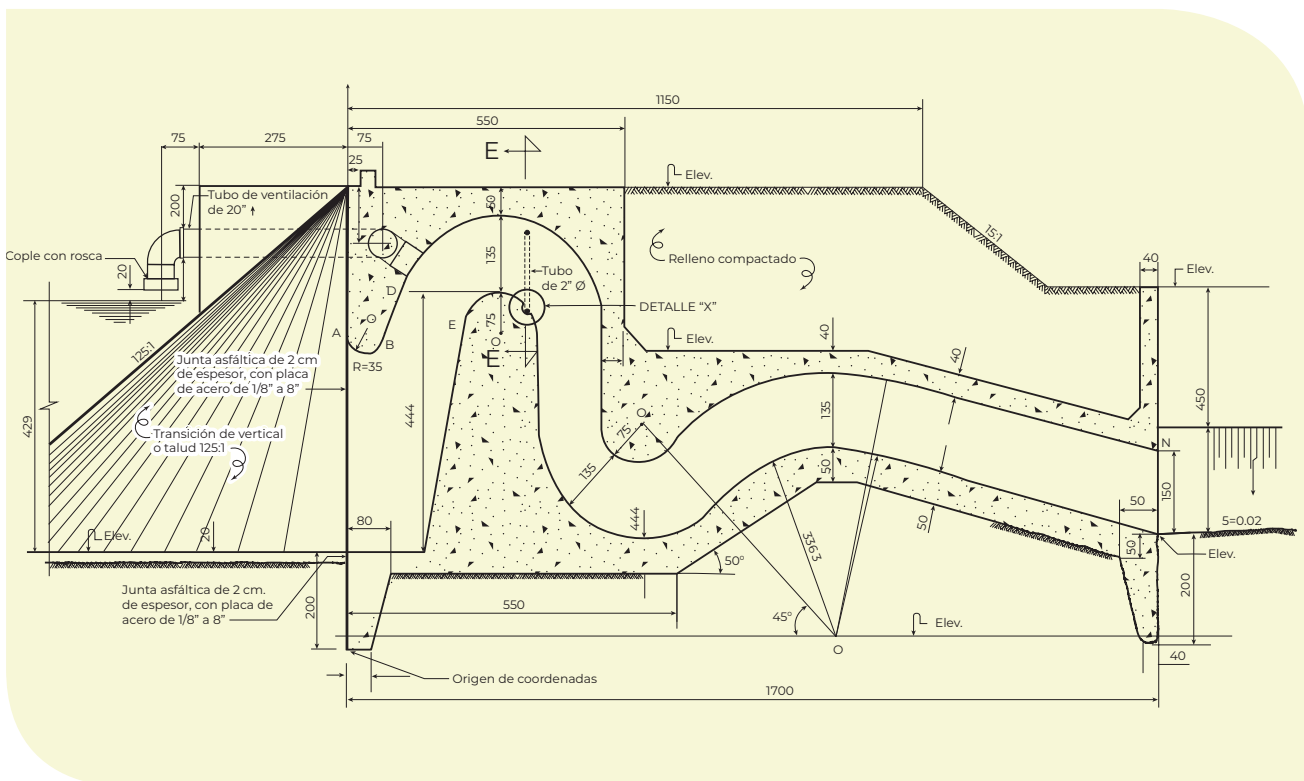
Corte longitudinal de un sifón automático. DR041 Río Yaqui, Son. (SRH, 1961)
